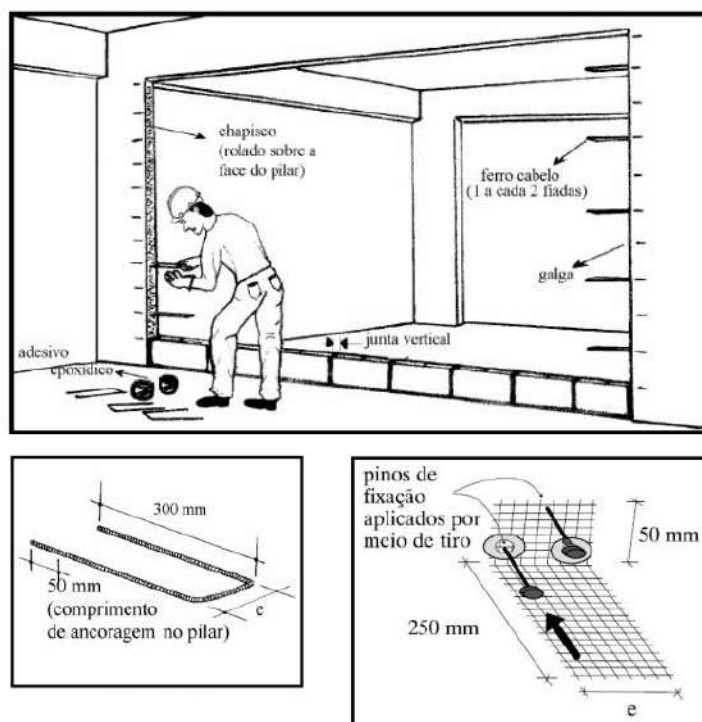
Ilustração do esquema de ligação alvenaria de vedação e pilar.
